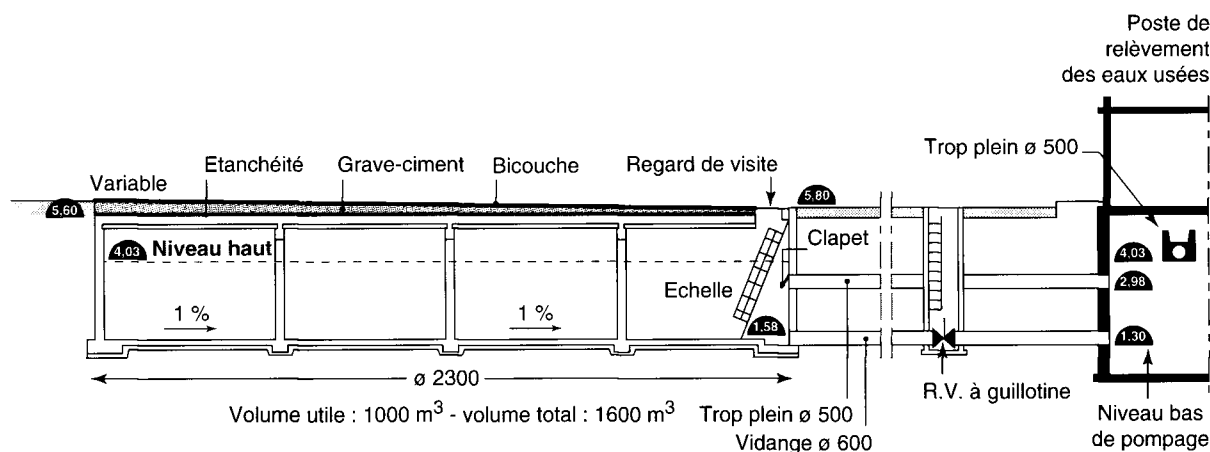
Coupe d'un bassin-tampon de fiabilisation de poste de relèvement.
